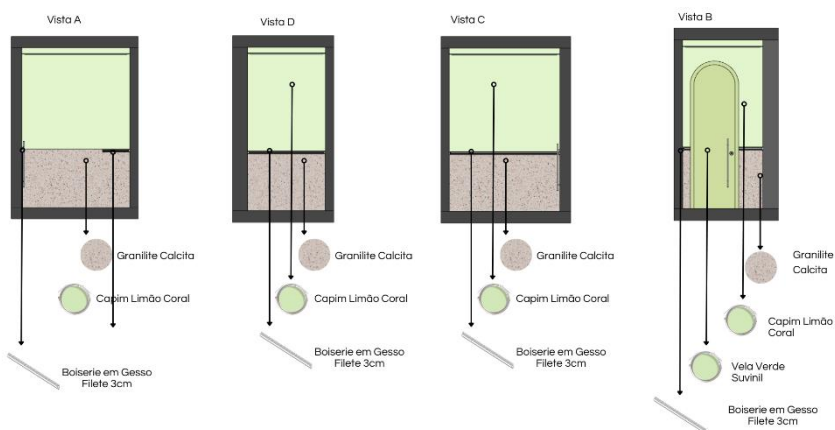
Banheiro Safari: Planta Baixa dos Acabamentos
